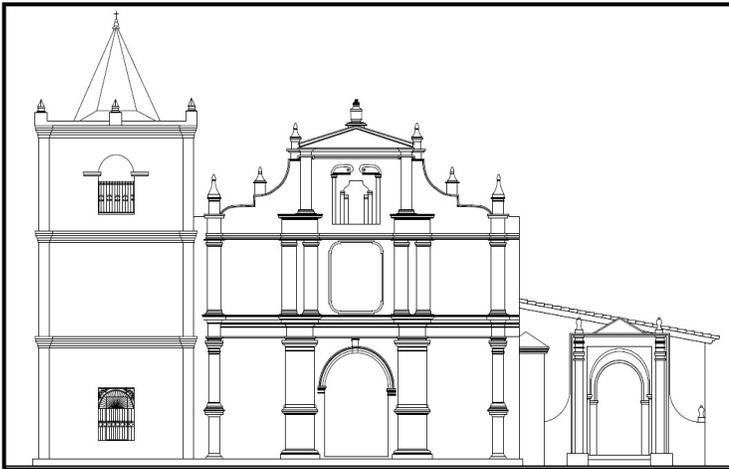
Fachada principal. Fuente: Grupo de trabajo.
